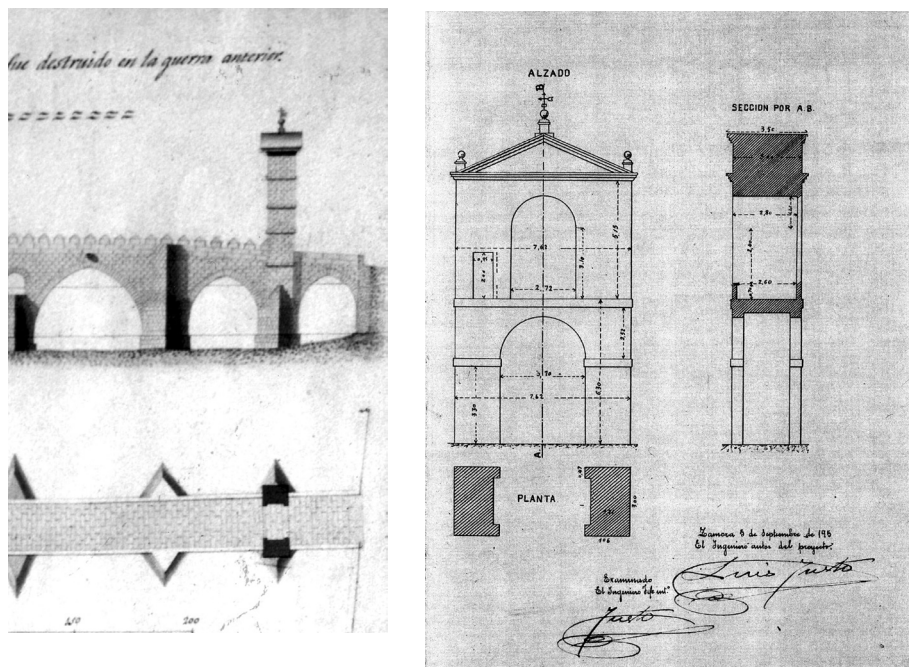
Torreón de La Gobernación. Planta en su posición sobre la pila 3.
